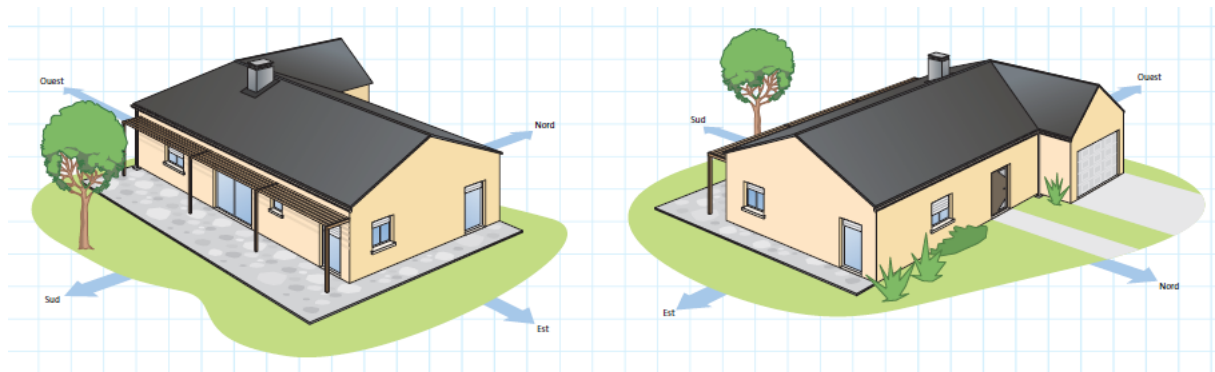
Das eingeschossige Gebäudemodell mit 100 m² Wohnfläche.
